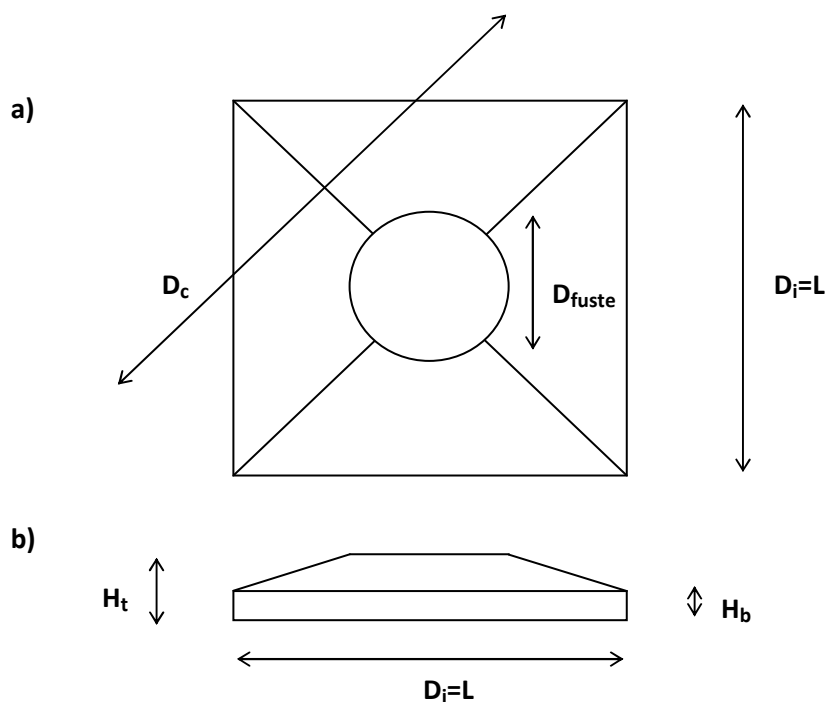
Zapata cuadrada: a) vista en planta, b) vista en alzado.
